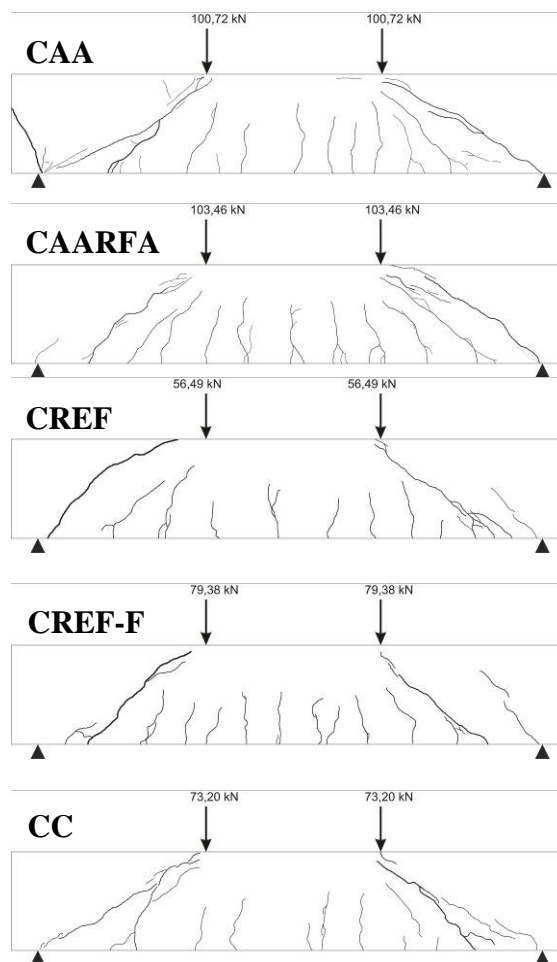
Configuração da fissuração nas vigas no momento da ruptura.
